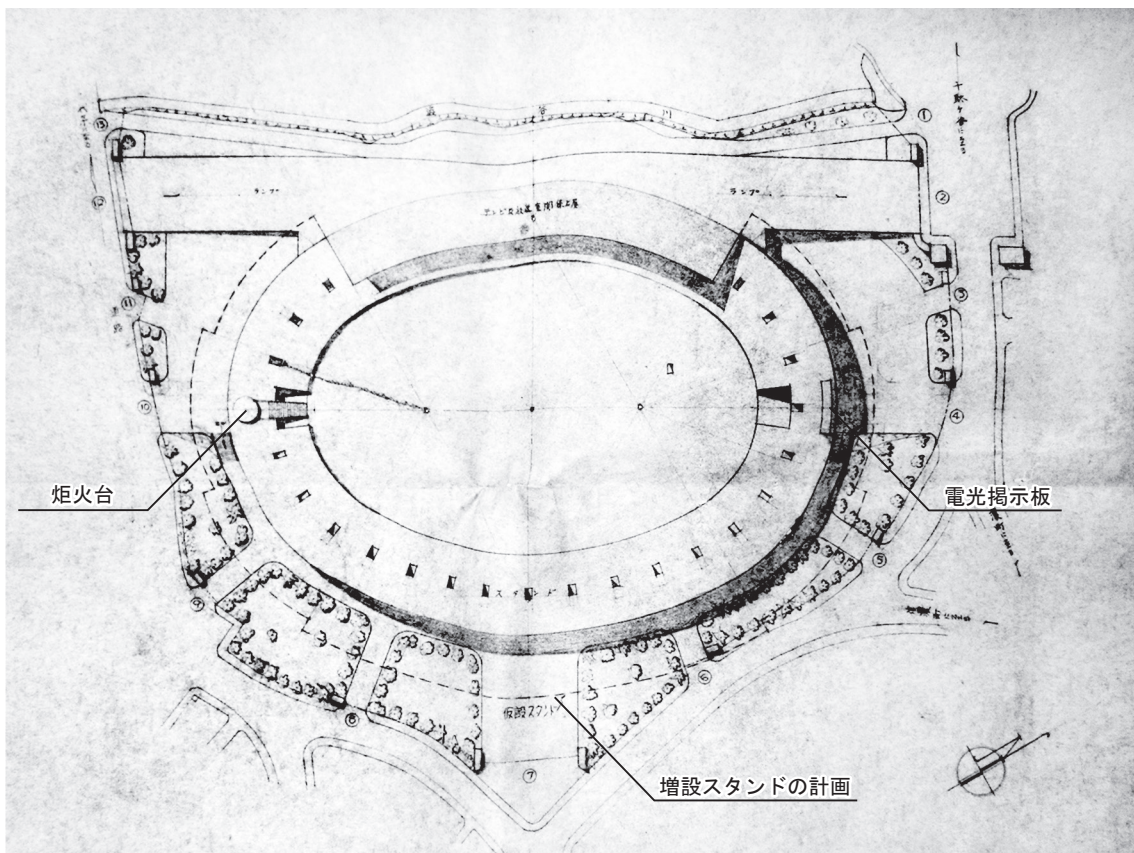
国立霞ヶ丘陸上競技場 基本設計配置図
